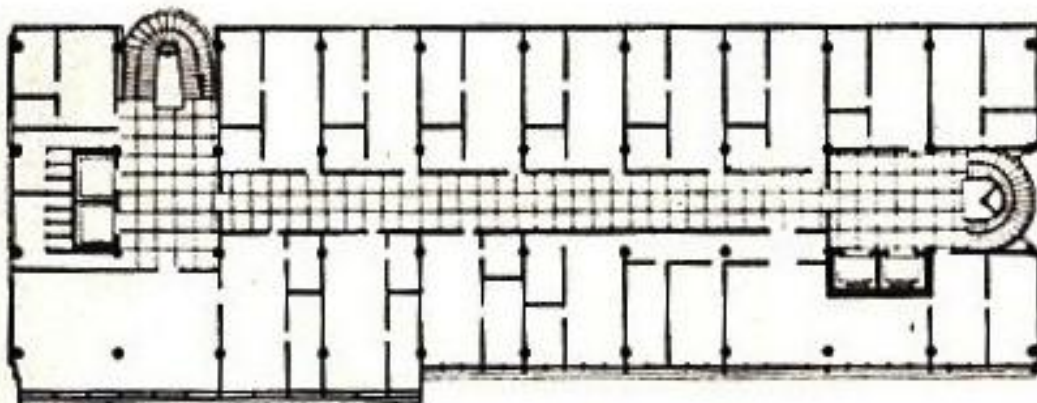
Grundriss des 3., 4., 5., 6. Geschosses, Büros.
